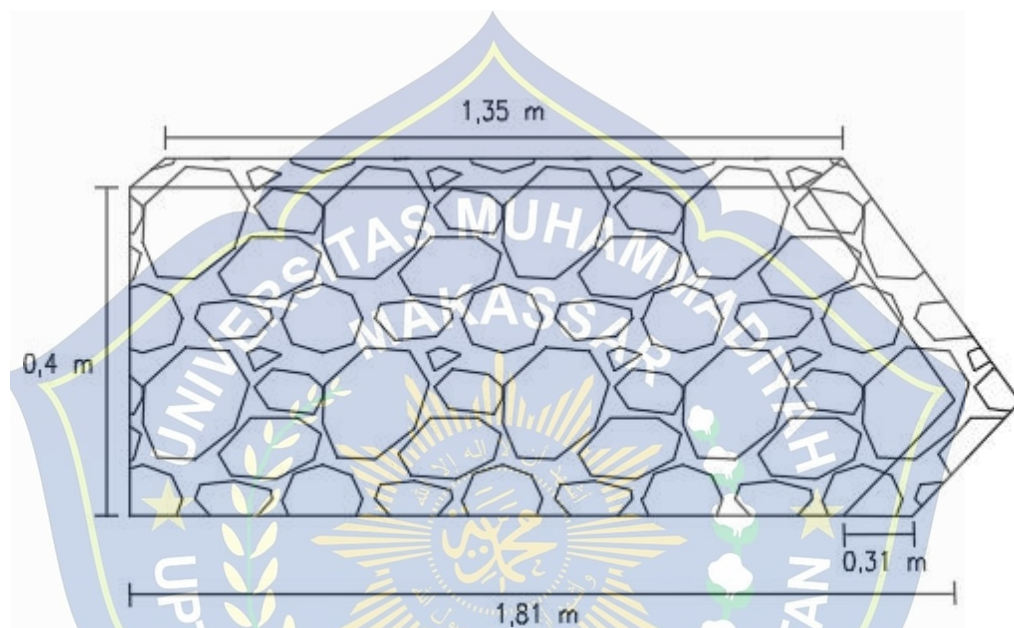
Detail Kerusakan 1 Pada Bangunan
